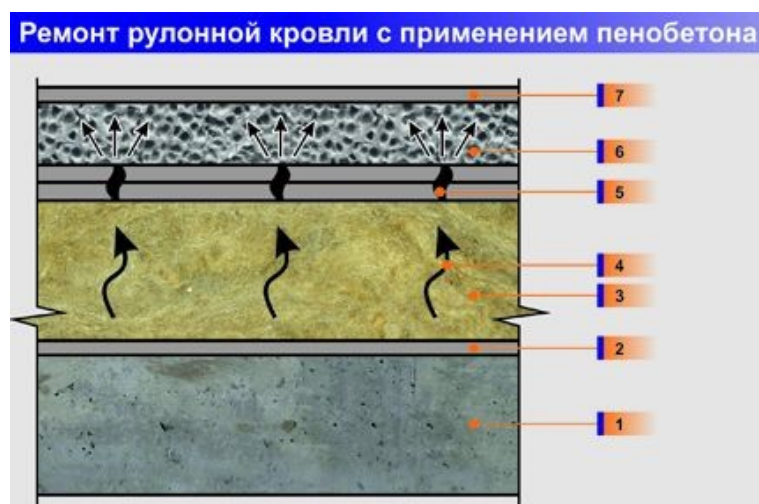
Разрез плоской кровли при реконструкции с использованием монолитного пенобетона.
